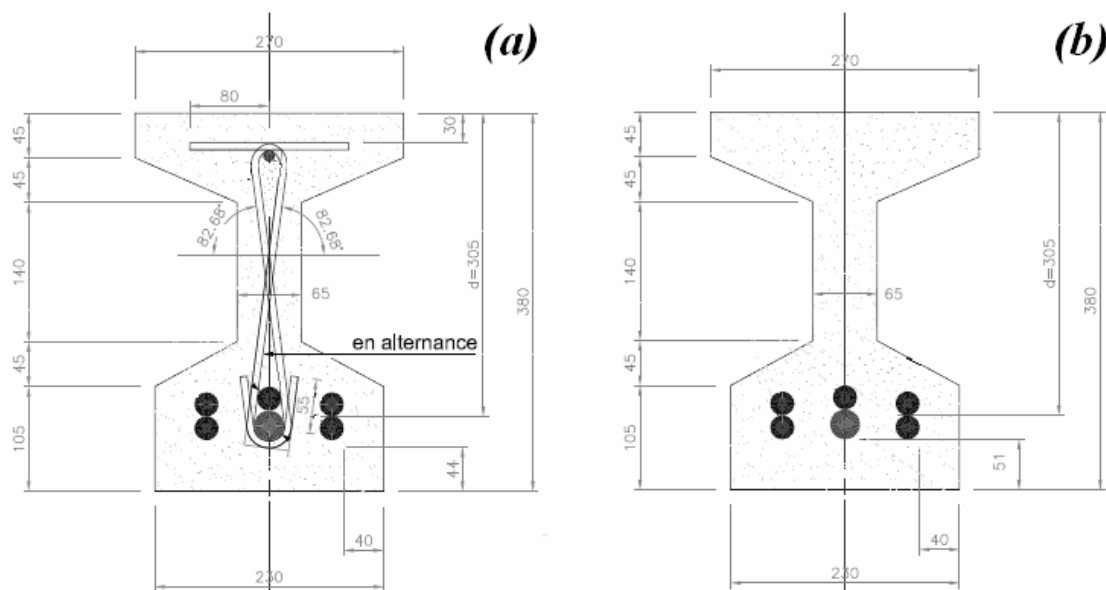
Section des poutres armées (dimensions en mm) : (a) poutres avec armatures transversales ; (b) poutres non armées transversalement (Armatures longitudinales : 5 HA20 et 1 HA25, Armatures transversales : 1 HA 6 tous les 7,5 cm).
